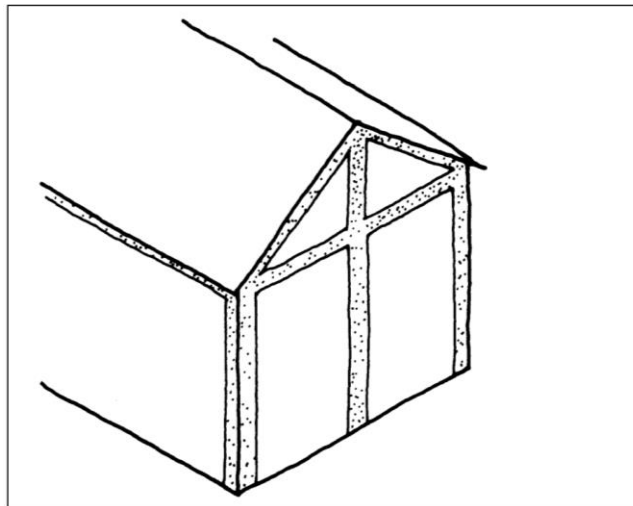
Tímpano Estabilizado con Estructura de Hormigón Armado. Adaptado de Minke, Manual de construcción para viviendas antisísmicas de tierra (2005)
